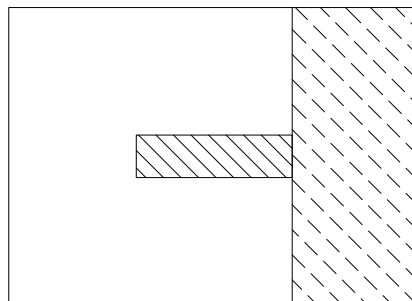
Sección considerada en voladizo para el diseño por flexión
